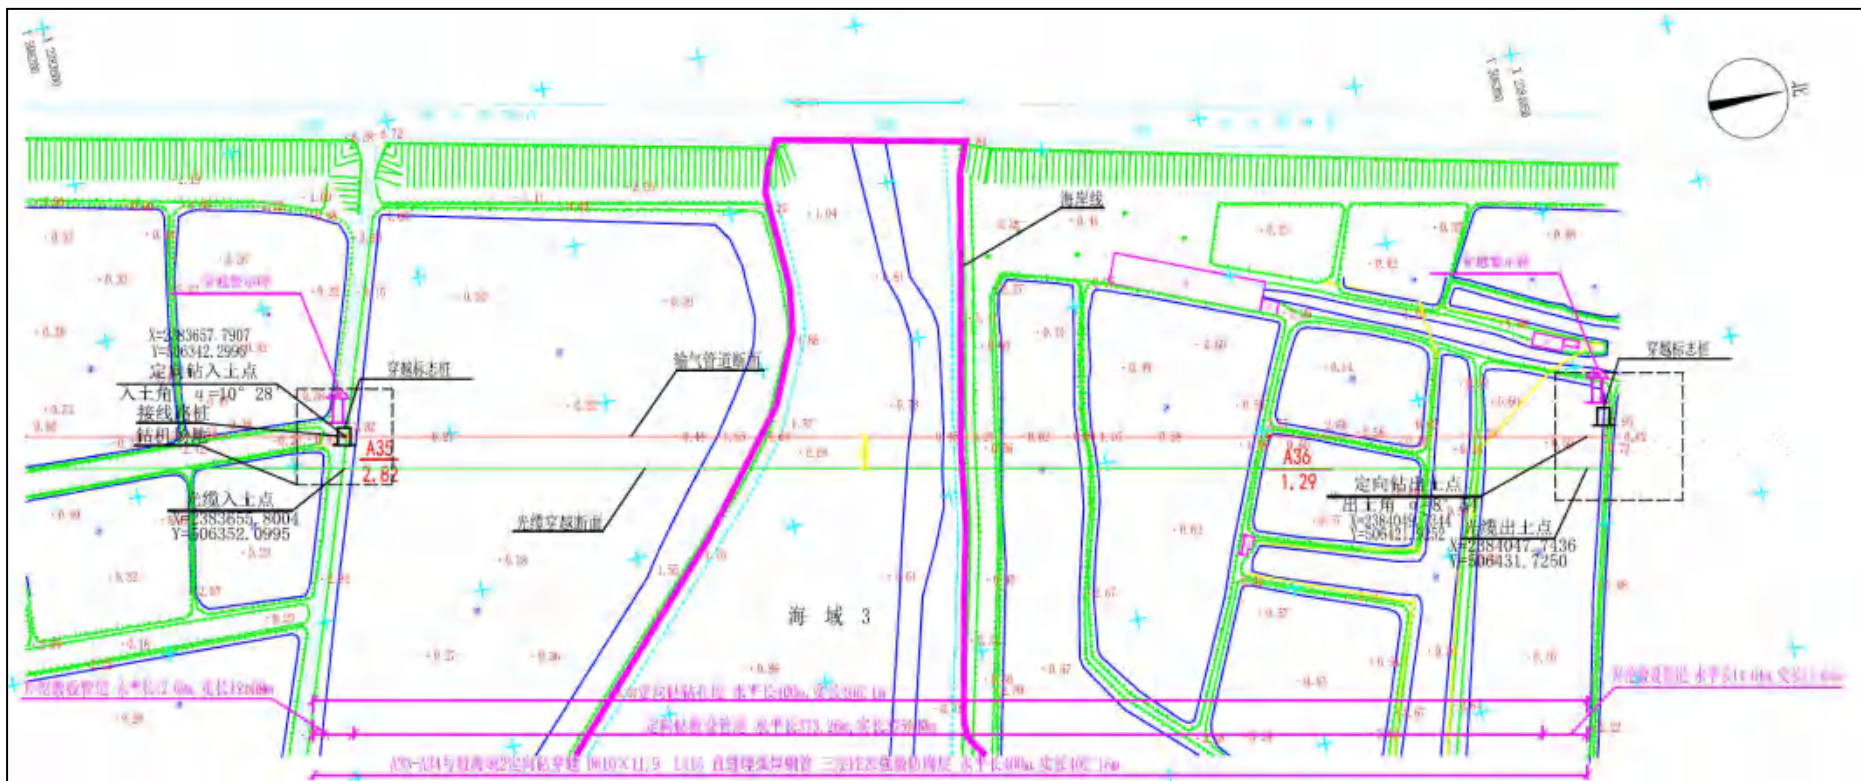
项目涉海段 3 管线定向钻穿越平面布置图
